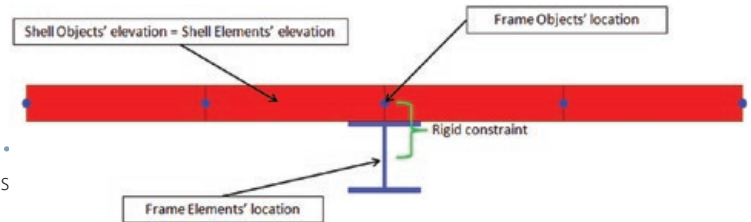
Excentricidade entre a laje colaborante e viga metálica
